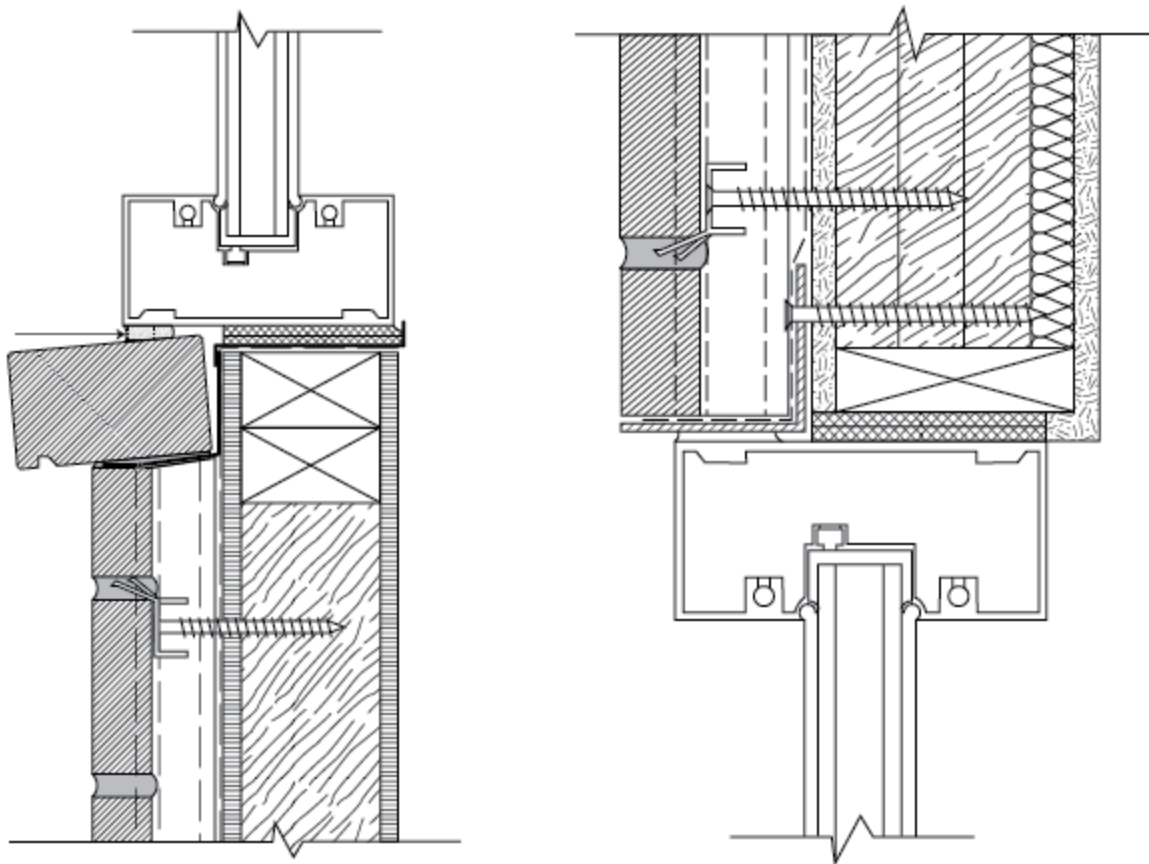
Coupe transversale de la jonction entre le produit et un appui de fenêtre ainsi qu'un linteau
